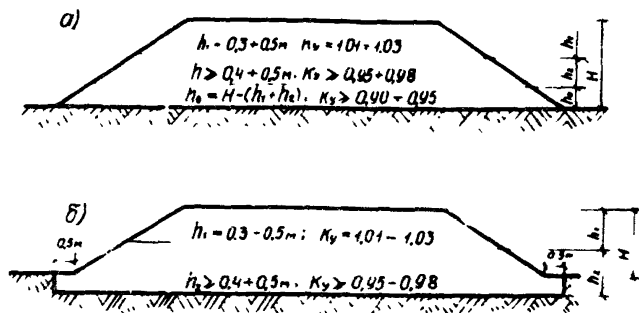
Схемы конструкции насыпи с повышенной плотностью грунта:
